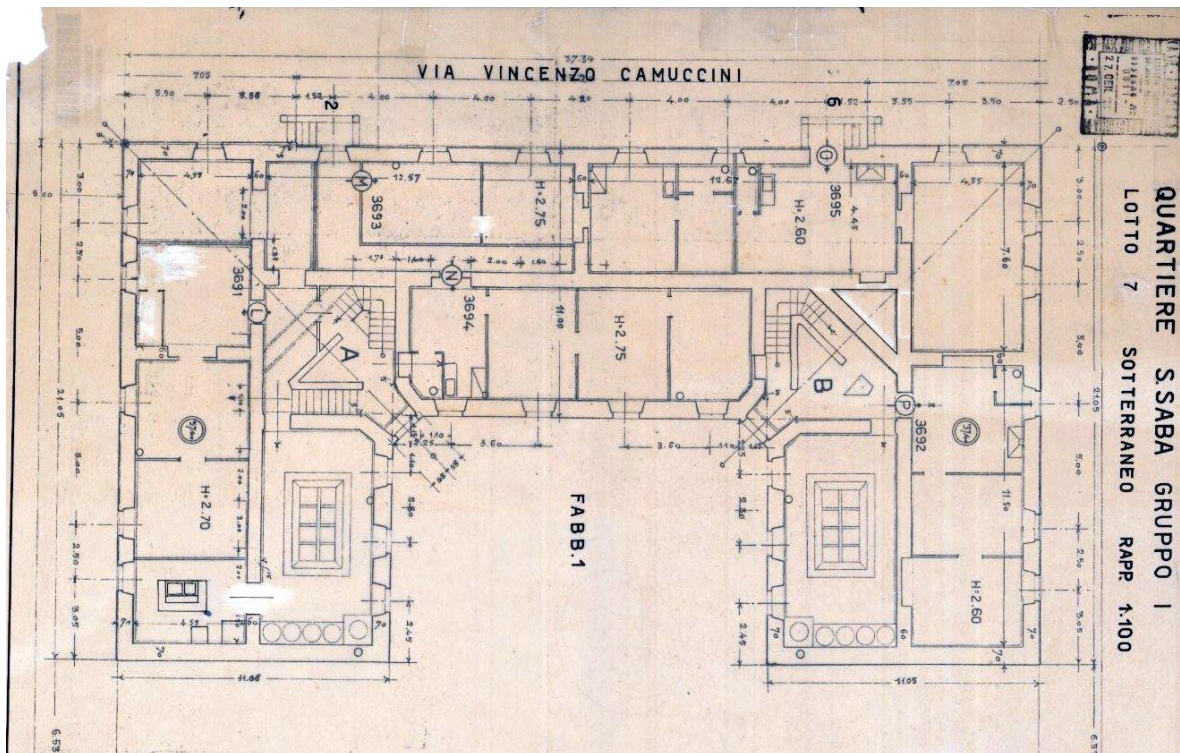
pianta piano interrato progetto originale Fabbricato 1 Lotto 7
